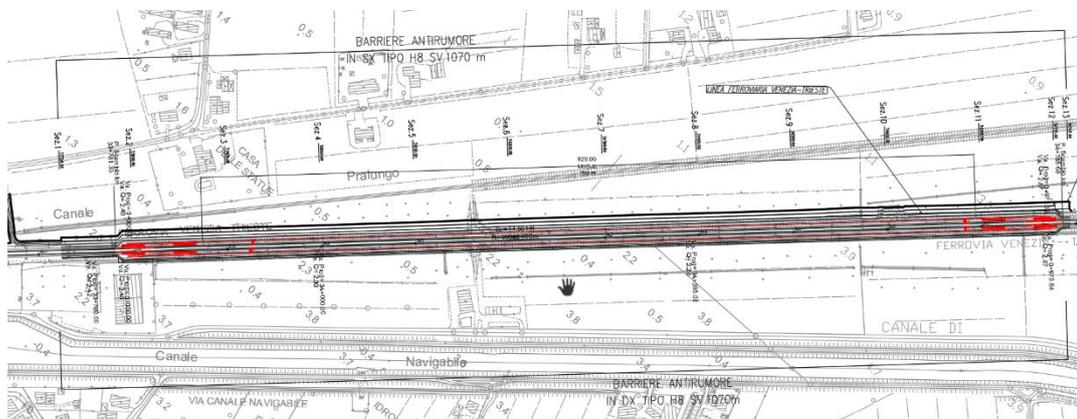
Stralcio planimetrico del nuovo Posto di Movimento di San Donà
